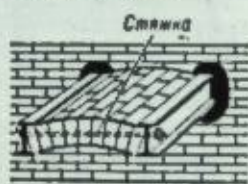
Основание под печь верхнего этажа в виде свода с металлической стеной.
